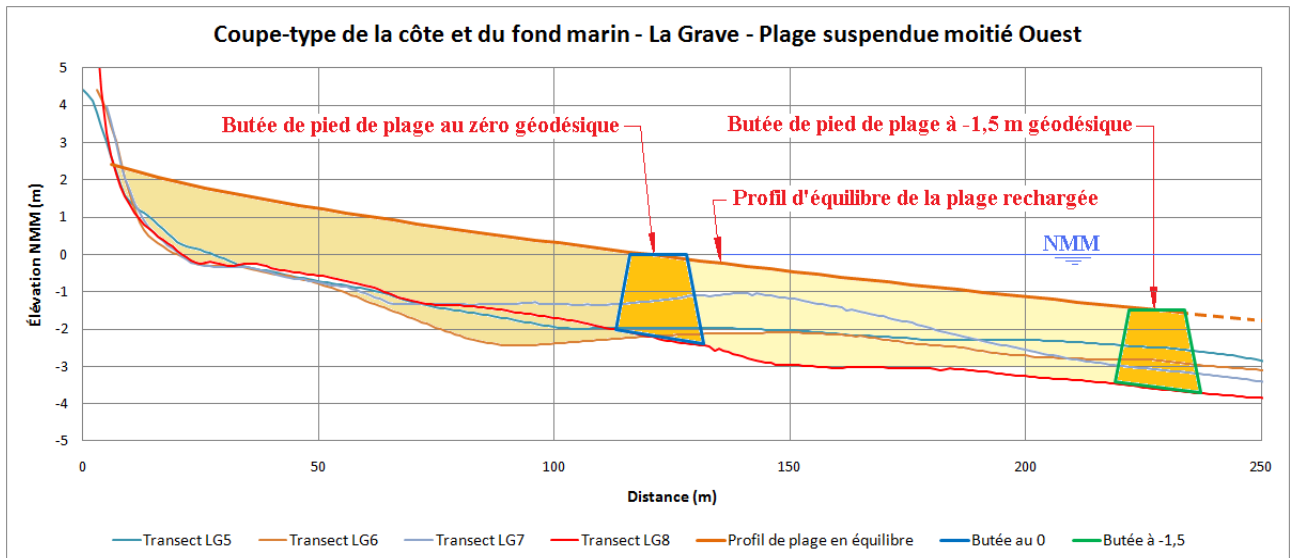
Coupe type d'une plage suspendue devant la plage de La Grave – partie ouest
